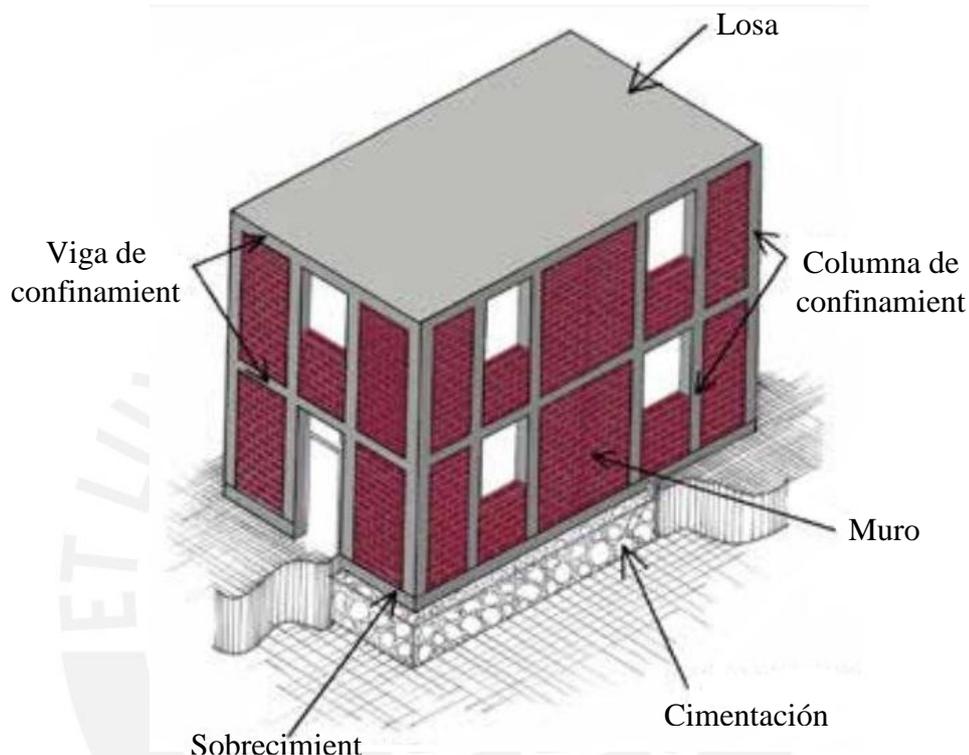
Elementos estructurales en un sistema albañilería confinada [37]
